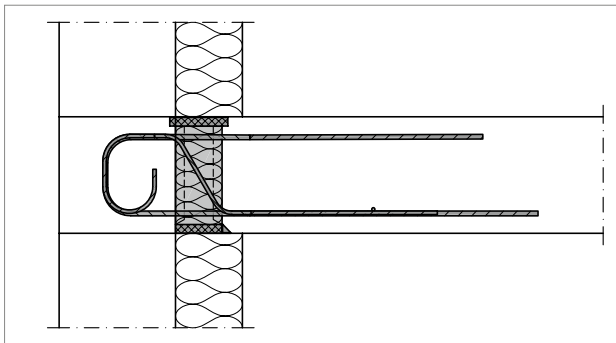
Schöck Rutherma® T type DF*i* : liaison pour façade en béton armé et dalle en béton coulé sur place
